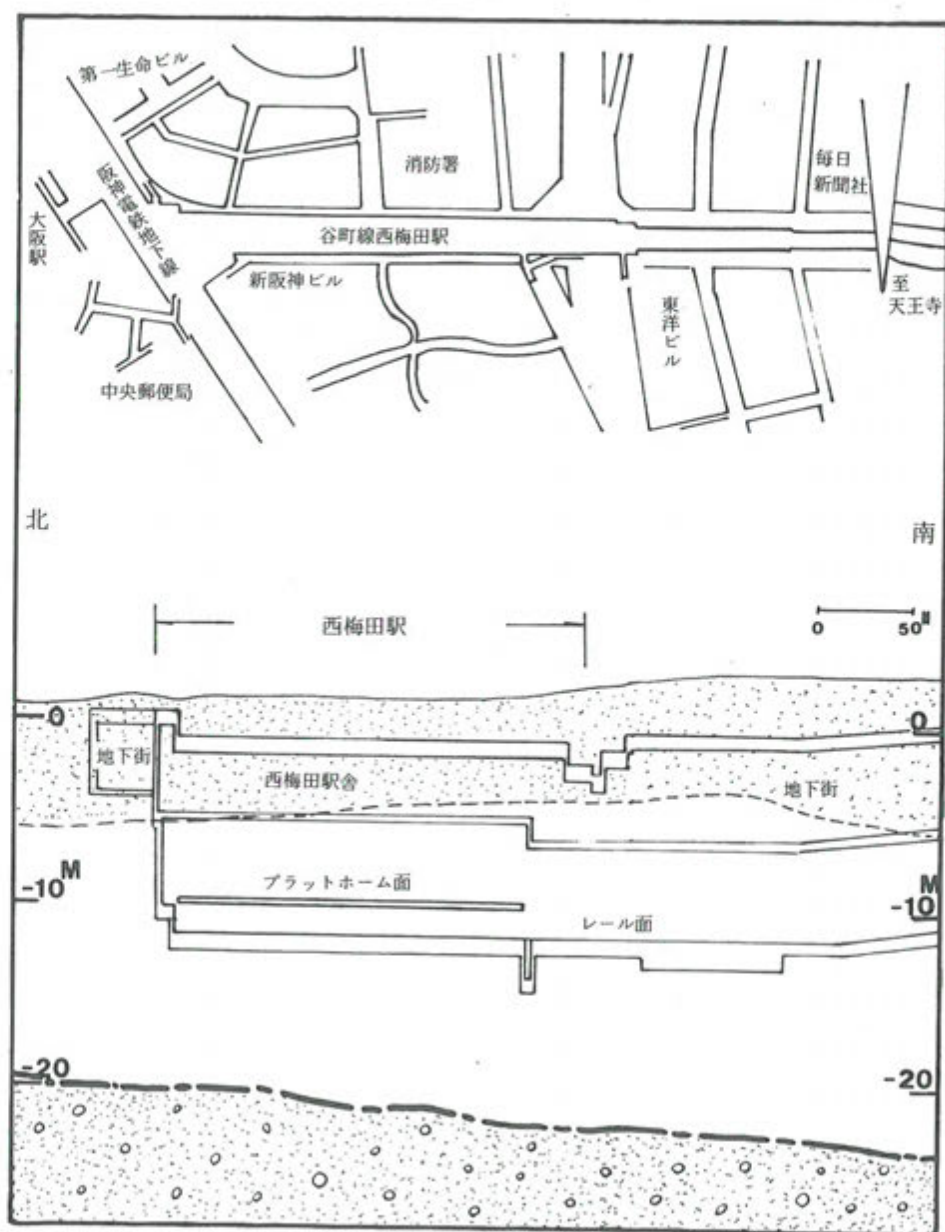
地下鉄西梅田駅付近の平面図と断面図（凡例は図2参照）
